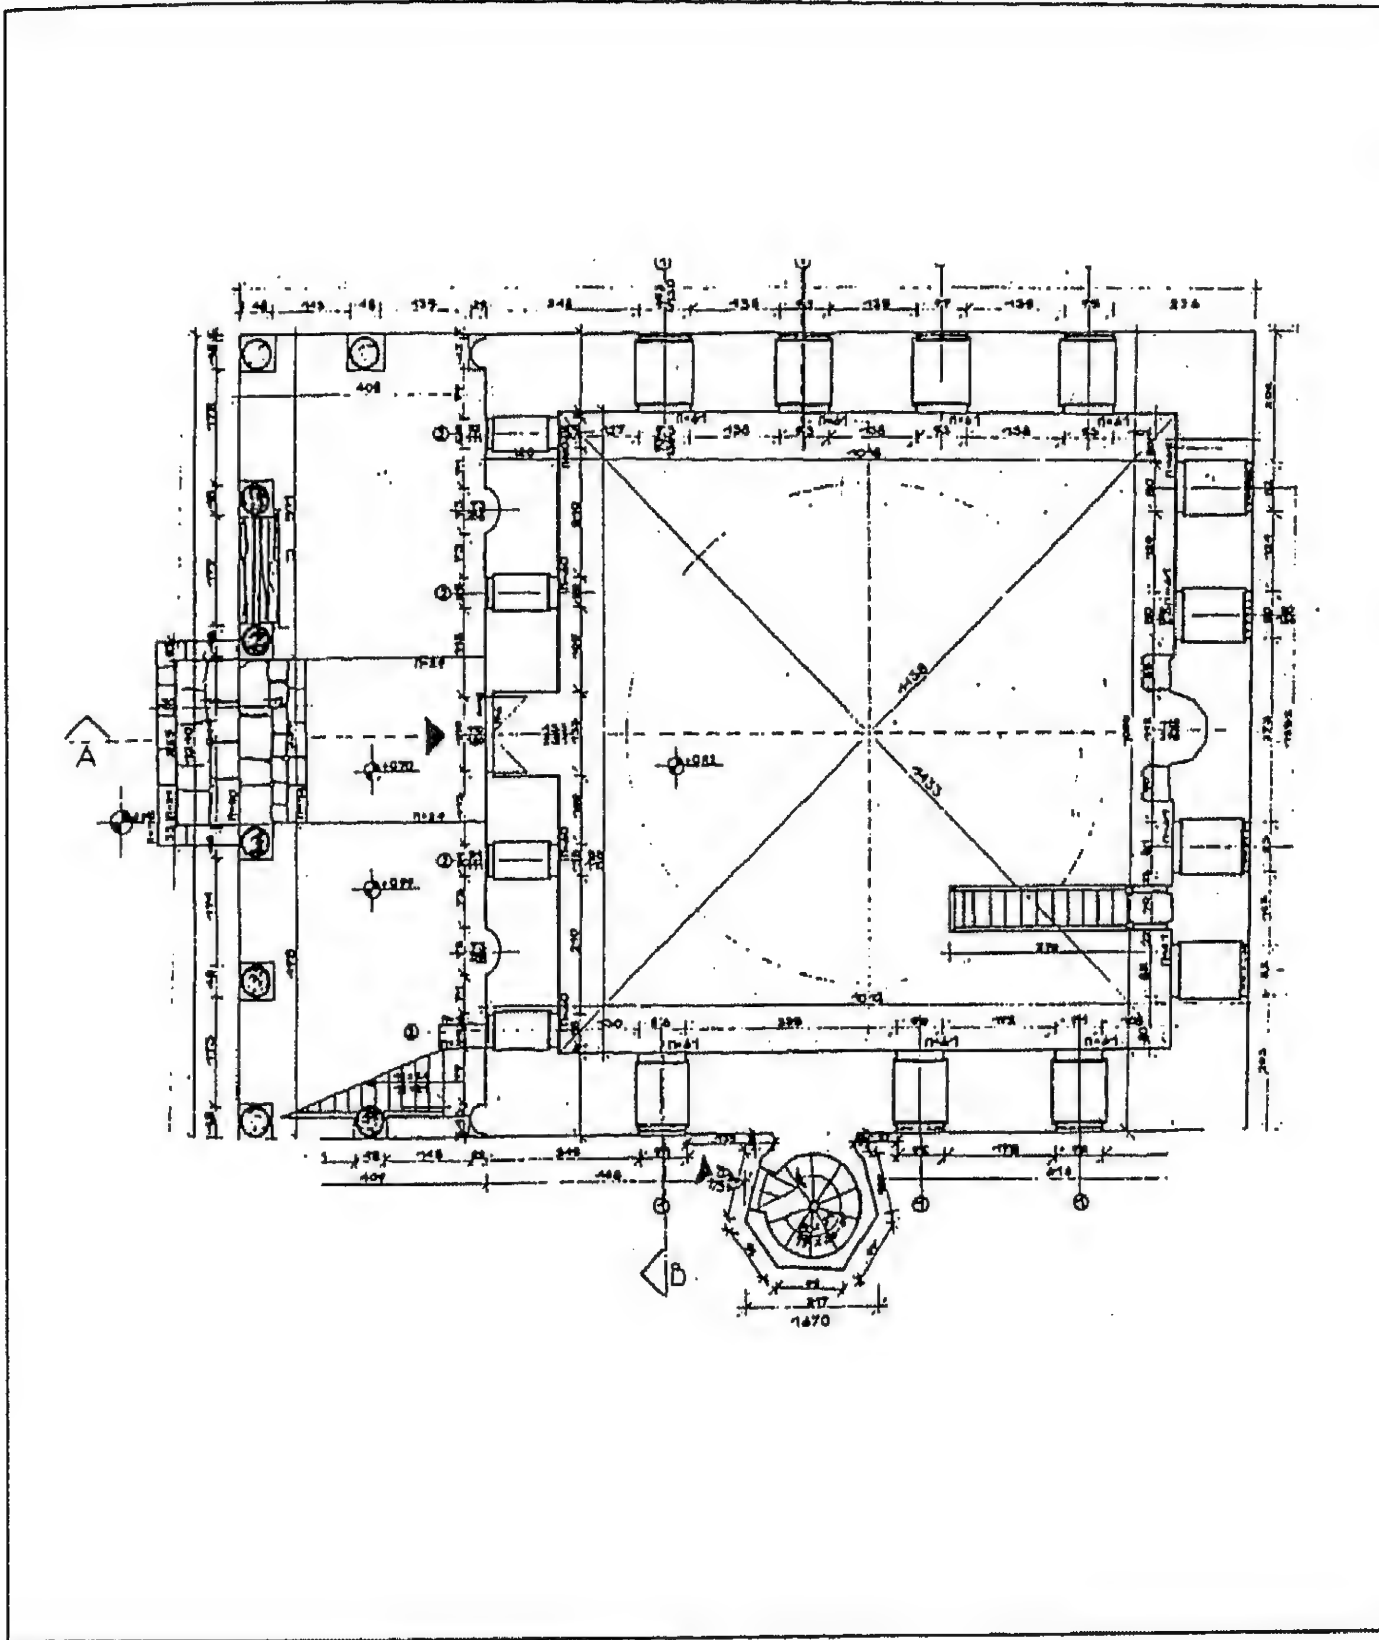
مسقط أفقي للمسجد الجديد (يني جامع) في كوموتيني (عن : كيل).
